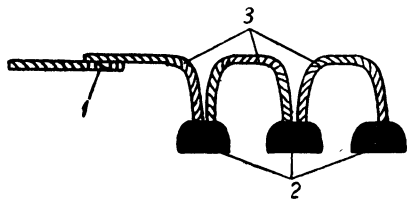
Схема последовательного соединения сети детонирующего шнура:
